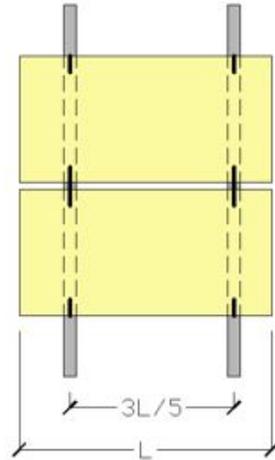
Esquema da instalação das pedras com fixação pelos topos horizontais
